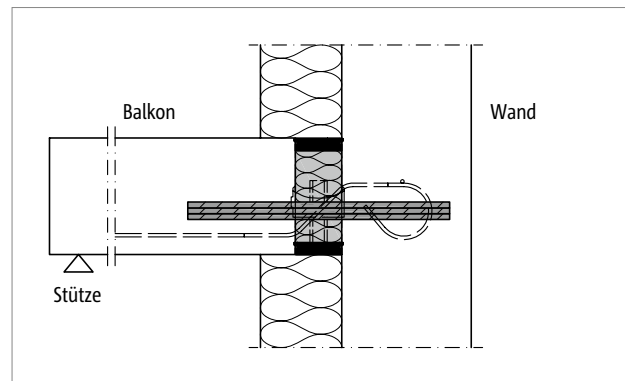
Schöck Isokorb® T Typ QL, HP-VV-NN: Anschluss an einer Stahlbetonwand mit Aussendämmung
